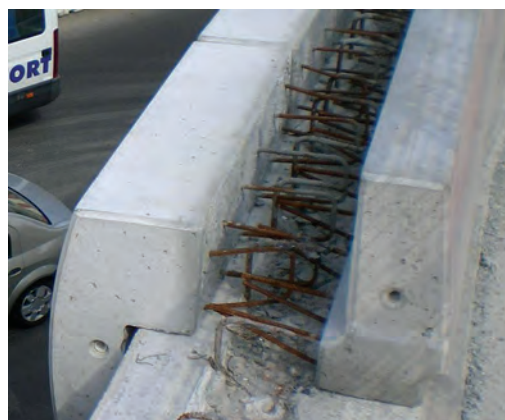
Lisă parapet și elemente prefabricate de bordură parapet înainte de betonare
